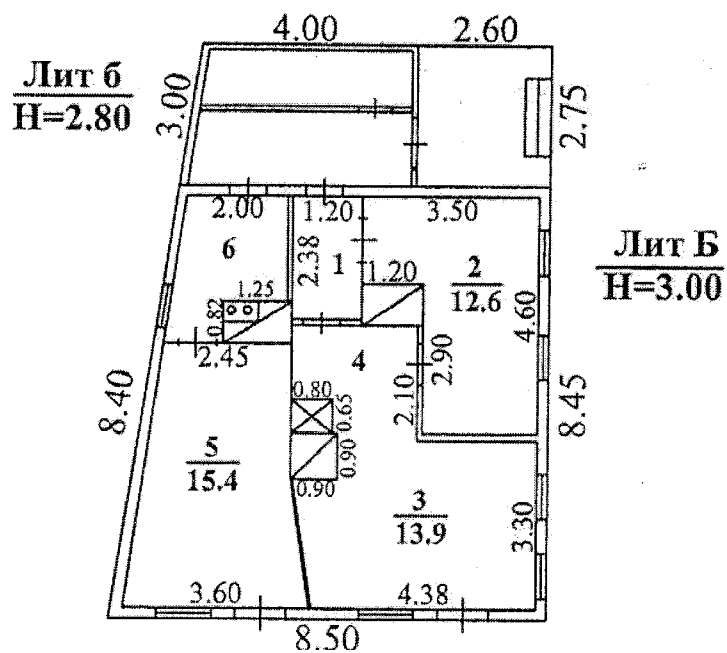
План этажа дома по ул. Борцов Революции, 11, лит. Б, Б1
